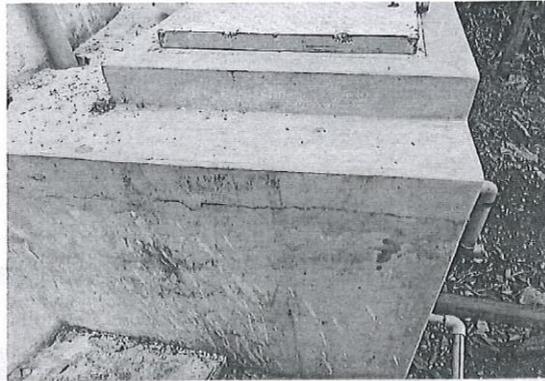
Fisuras en concreto de cajas y válvulas en sistema de agua potable.
